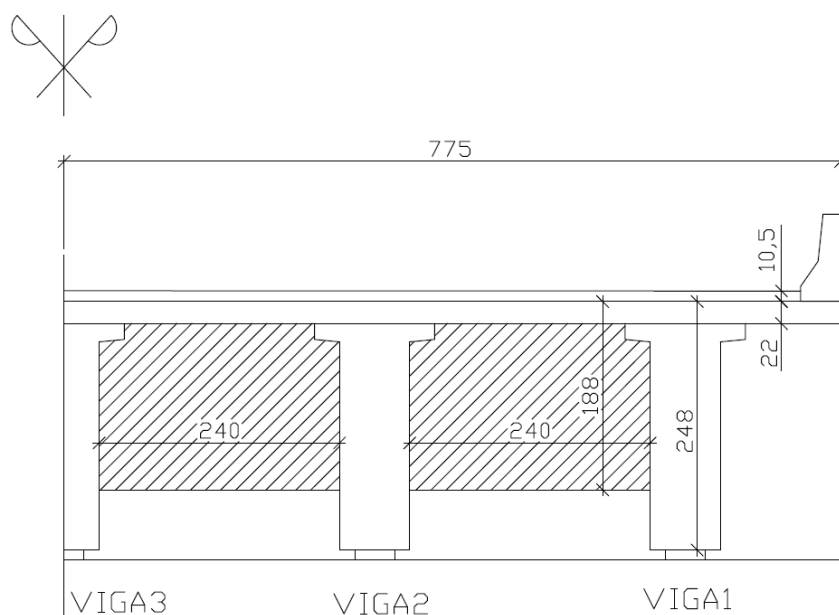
Detalhe da seção S1 da planta de fôrma da ponte rodoviária
